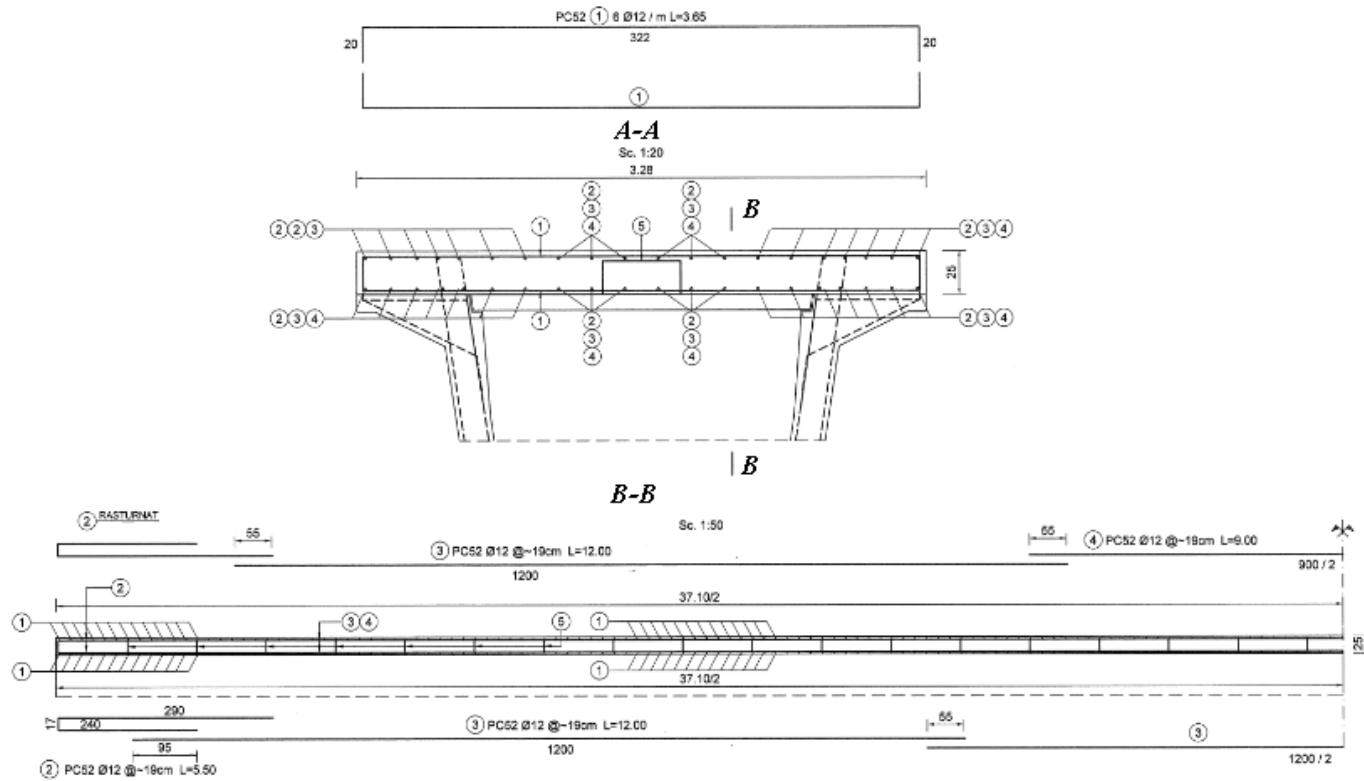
Plan armare suprabetonare grinda chesonată, L=37.10 m
